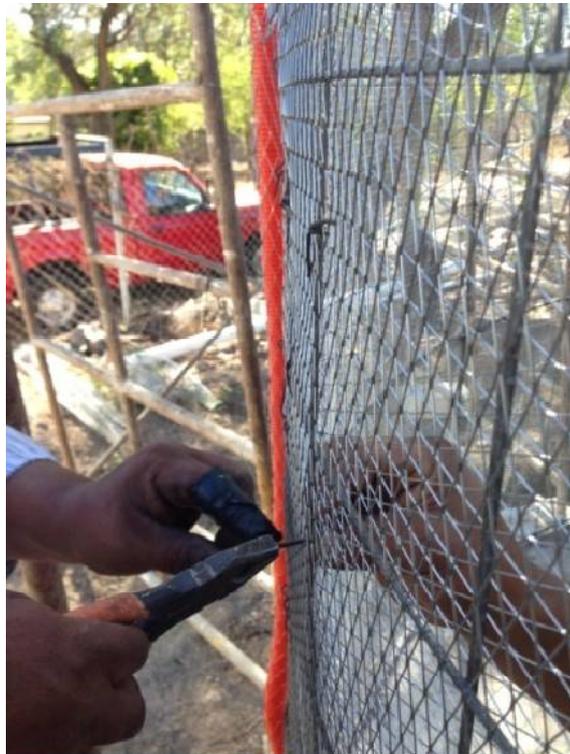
Fotografía de engrapado de muro utilizando pinzas mecánicas, autoría propia
